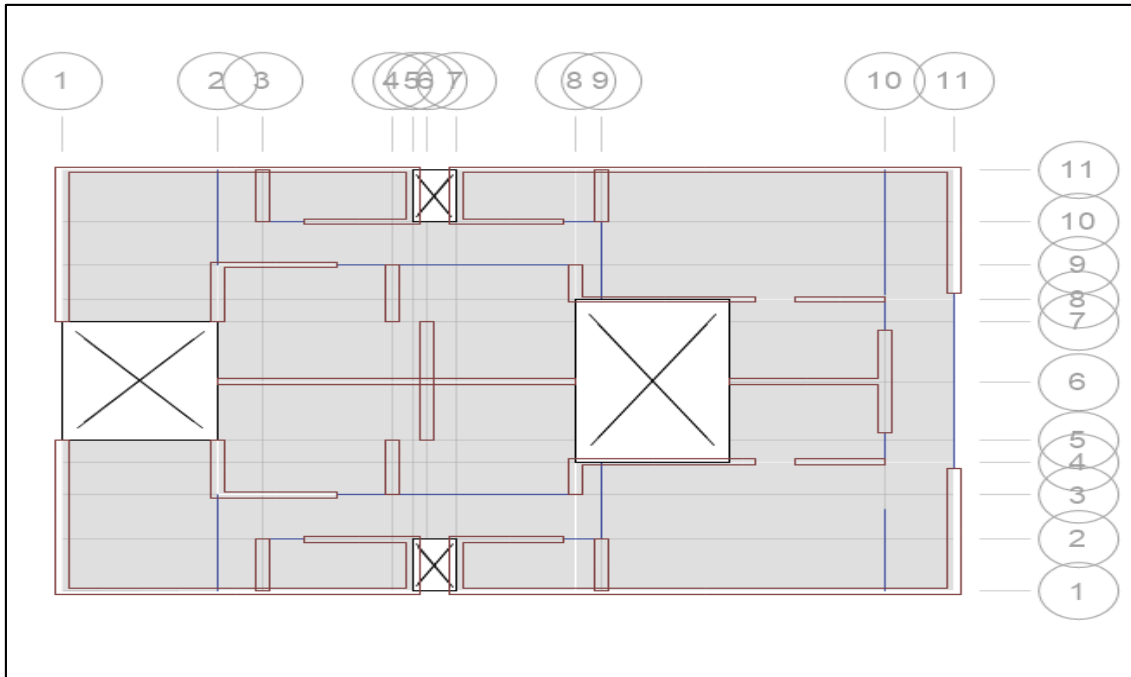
Vista en Planta del Sistema de Albañilería Confinada.
